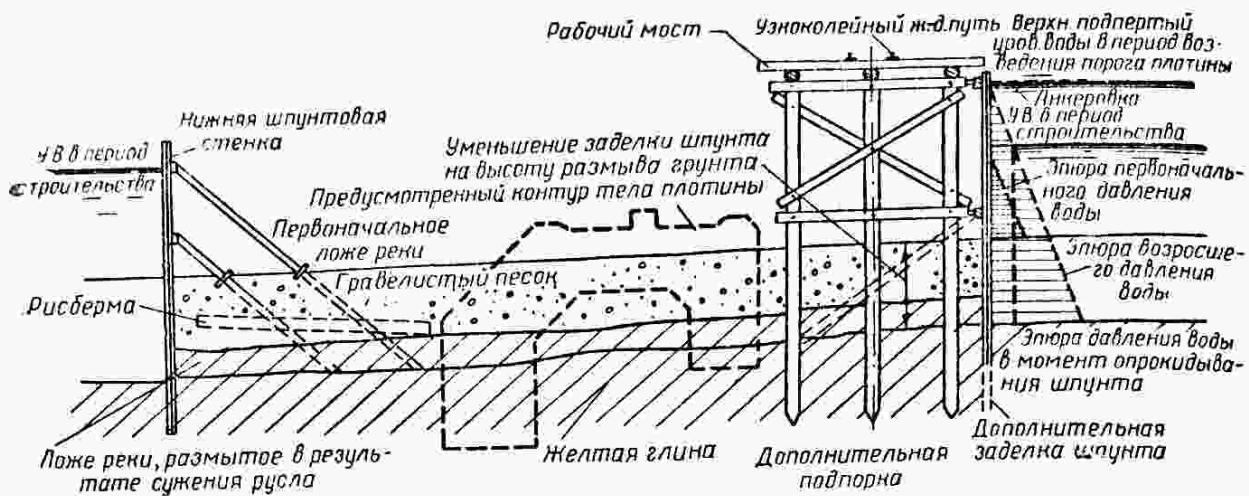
Схема системы поддерживания верхней и нижней шпунтовых стенок в котловане
